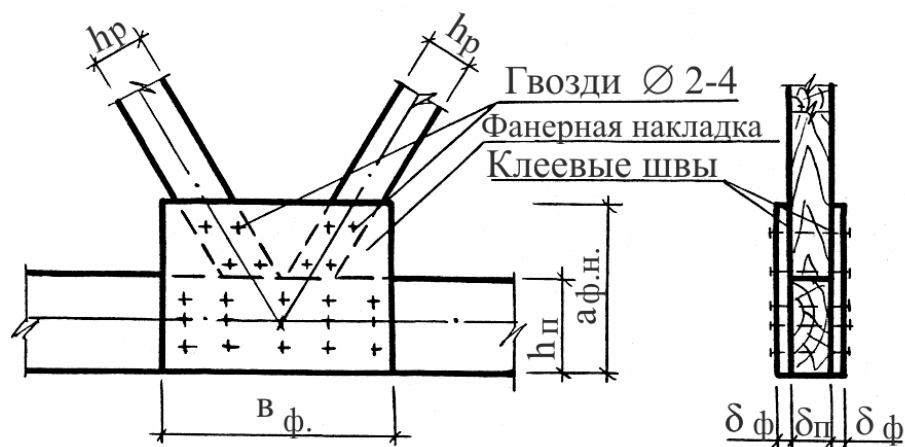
Промежуточный узел фермы с фанерными накладками
